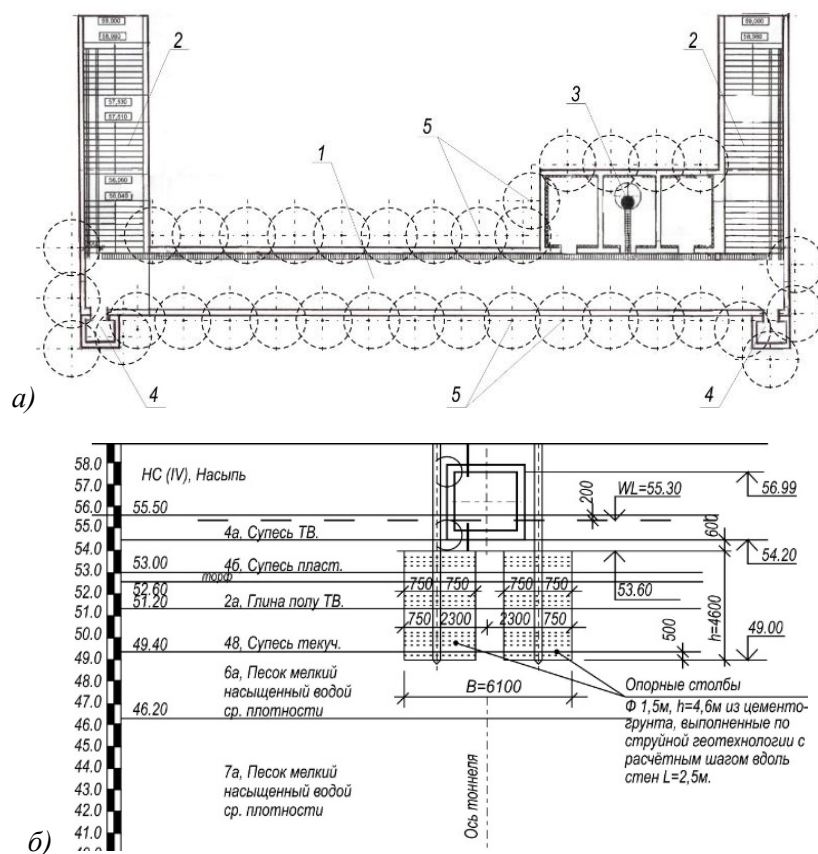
Усиление слабого водонасыщенного грунта основания под подошвой плитного фундамента подземного пешеходного перехода на пересечении улиц Эсперанто- Качалова методом подведения вертикальных цементогрунтовых армоэлементов с наружной стороны сооружения, выполненных по технологии струйной цементации. а - план подземного перехода с расположением вертикальных цементогрунтовых армоэлементов; б - поперечный разрез ствола подземного перехода с элементами усиления; 1- ствол перехода; 2-лестницы; 3-приямок; 4-лифты; 5-элементы усиления из цементогрунта
